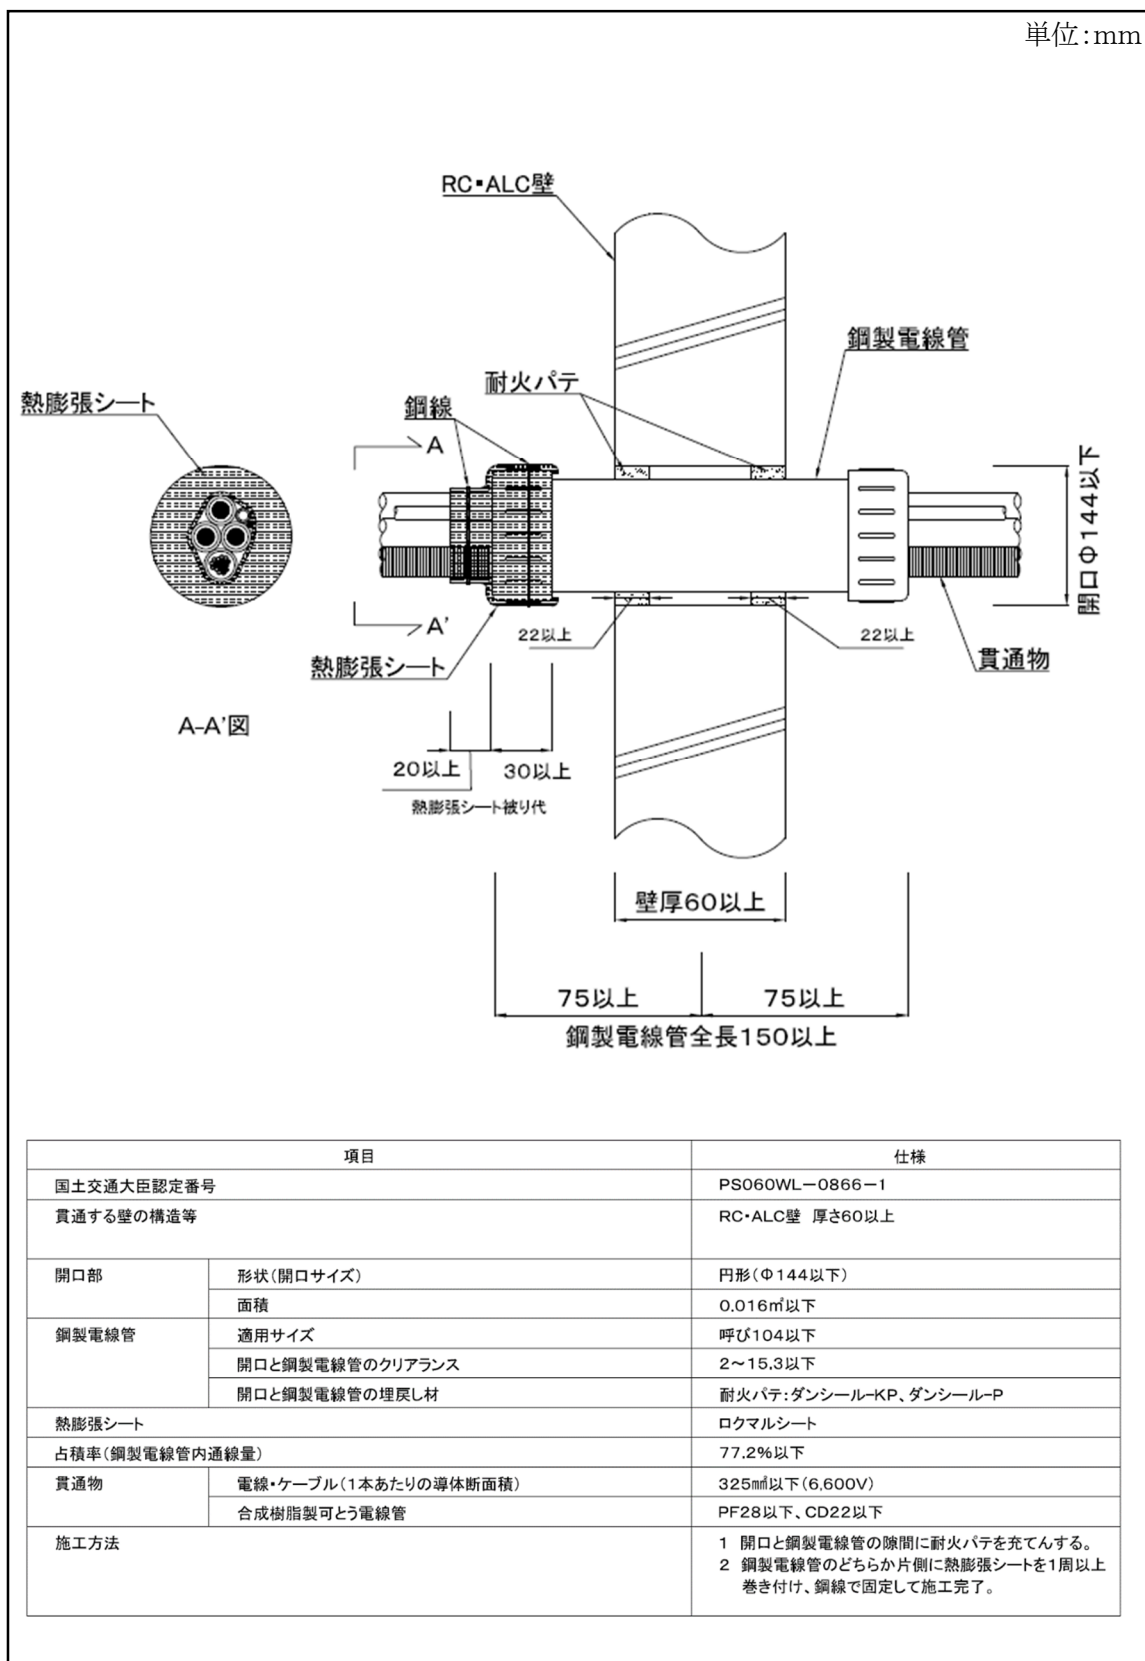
鉄筋コンクリート・ALC 壁(PS060WL-0866-1) 標準施工図
